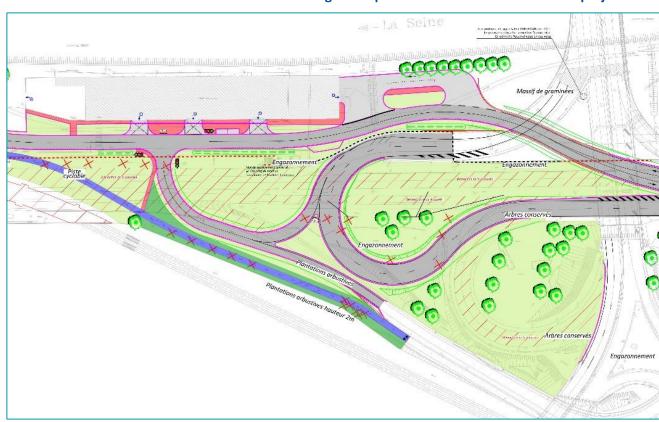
Plan de raccordement des bretelles de l'échangeur sud du pont Mathilde avec la nouvelle voie, en situation définitive
